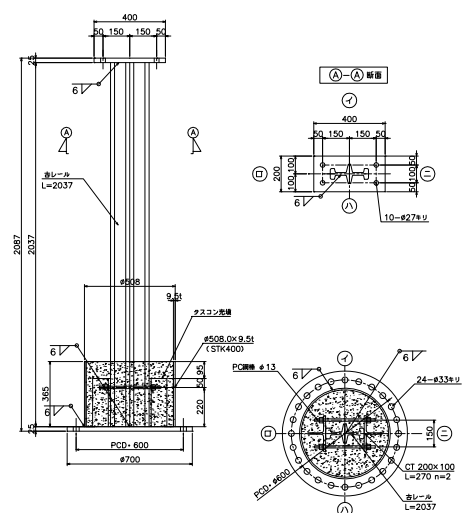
試験体概要図(試験体 No. 3(強軸方向載荷))
